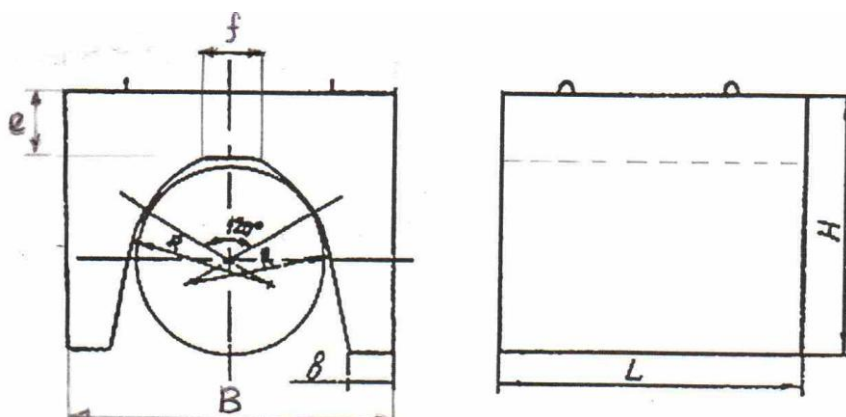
Железобетонный утяжелитель типа УБК 1020-9А
